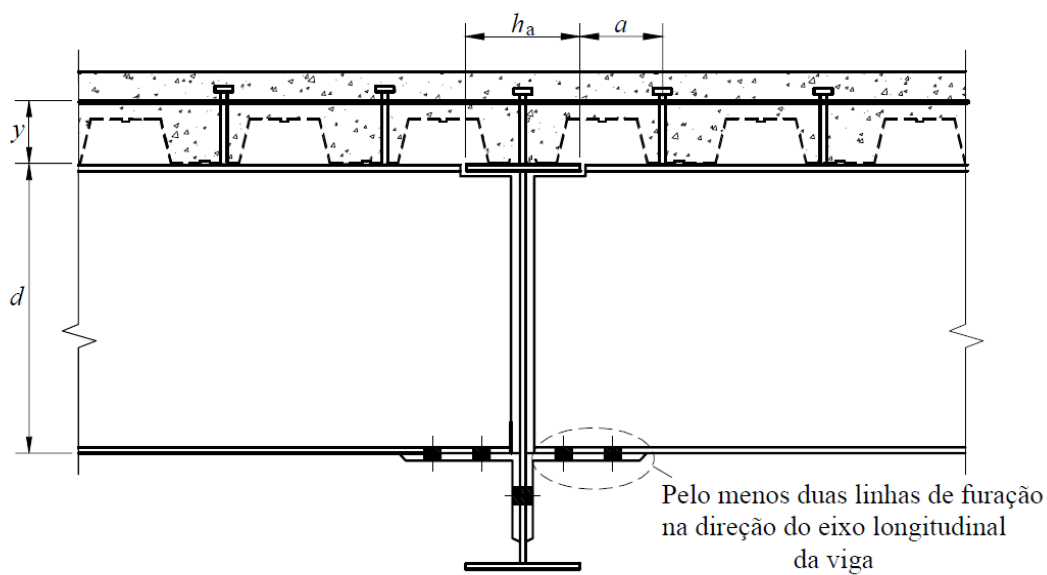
Ligação mista com cantoneira parafusada na mesa inferior da viga apoiada [NBR 8800:2008]
